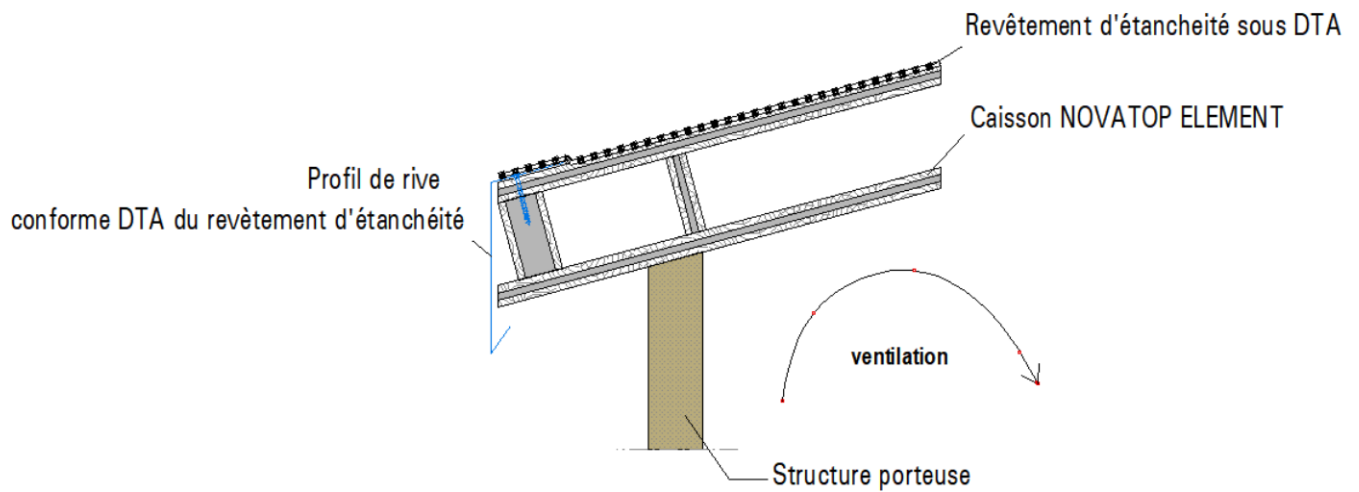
B2 – Rive de toiture froide ventilée (Auvent, préau, bâtiments ouverts non isolés, non chauffés) - revêtement d'étanchéité autoprotégé monocouche
